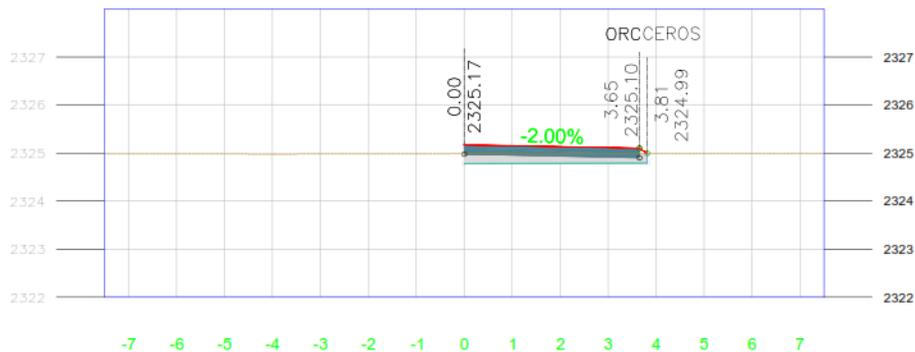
Sección transversal km 0+070.00 del camino de acceso.
